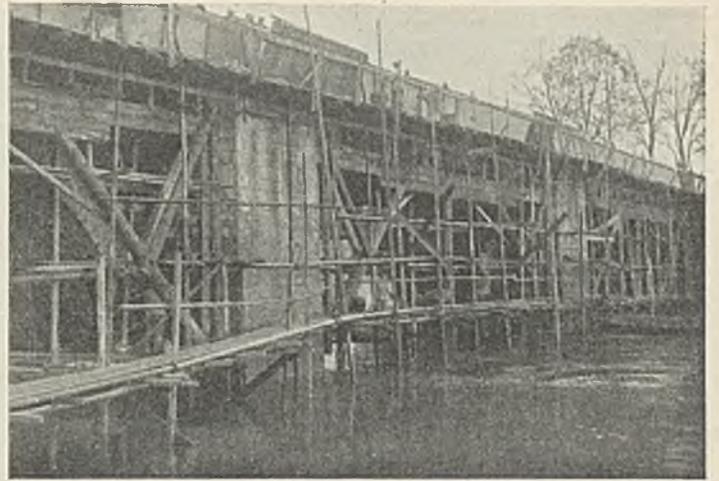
Ausspritzen des alten Mauerwerks mit Zement.
